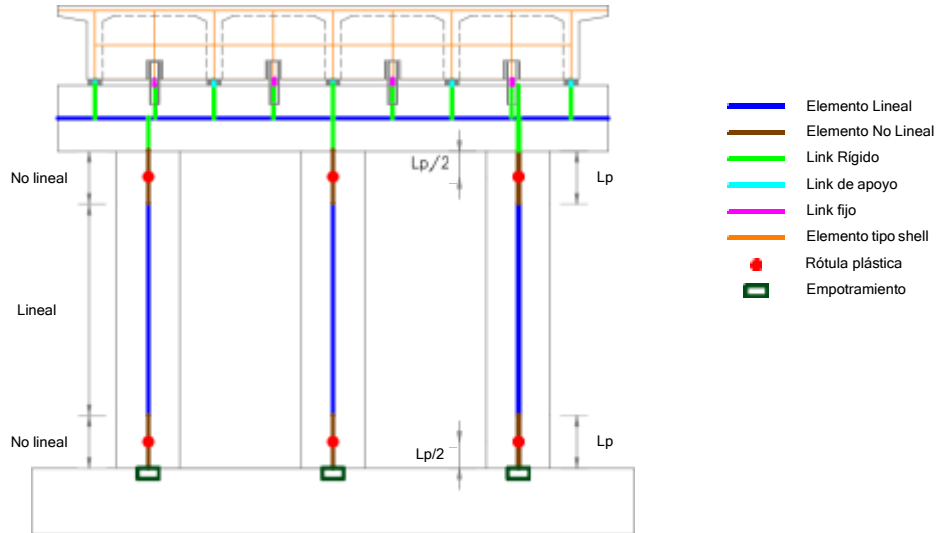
Modelación típica de pilar (aplicable para pilares con 2 o 3 columnas).
